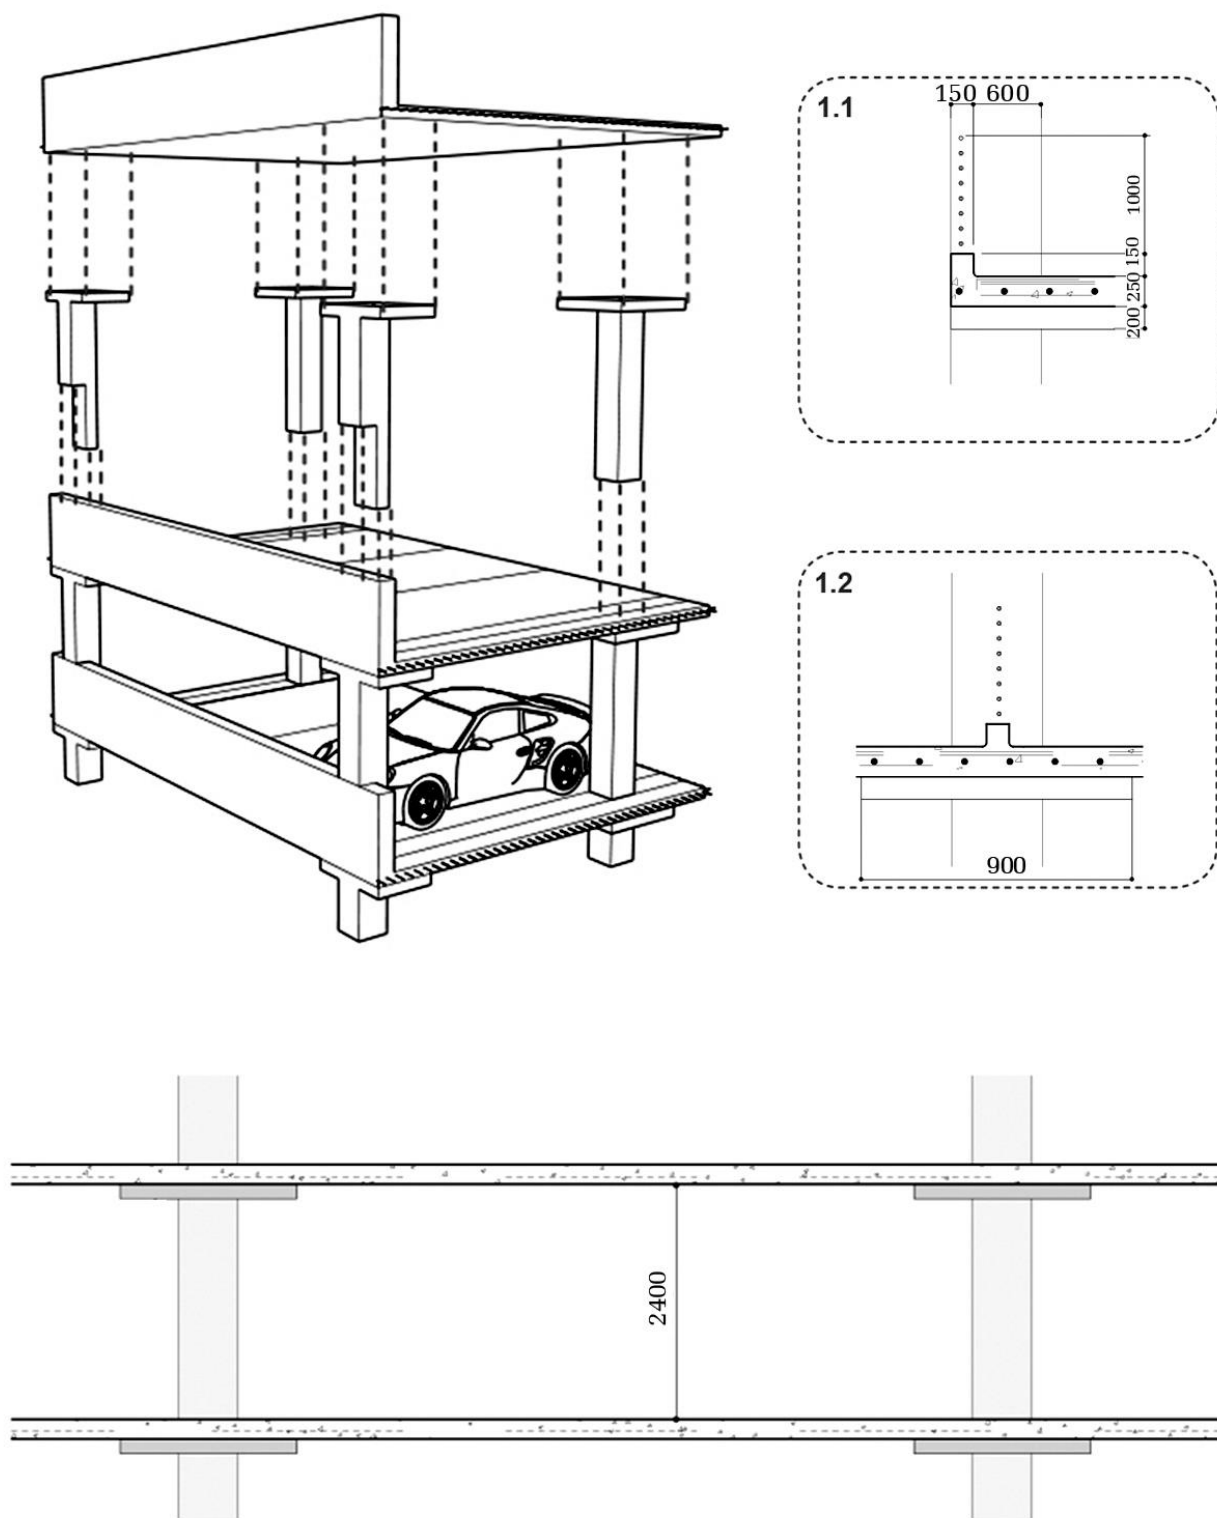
Схематичное изображение опирания панели перекрытия на капиталь колонны.
